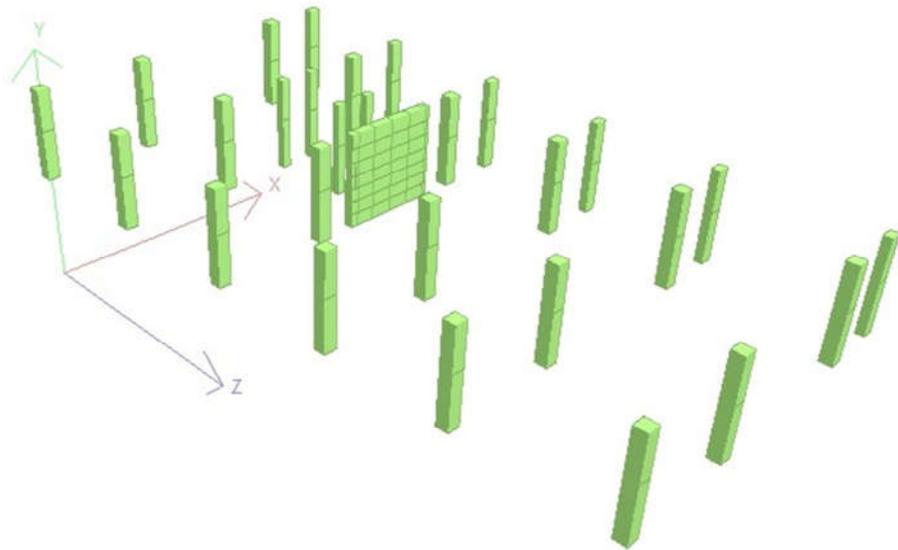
Render hasil potongan berat bangunan lantai 2
